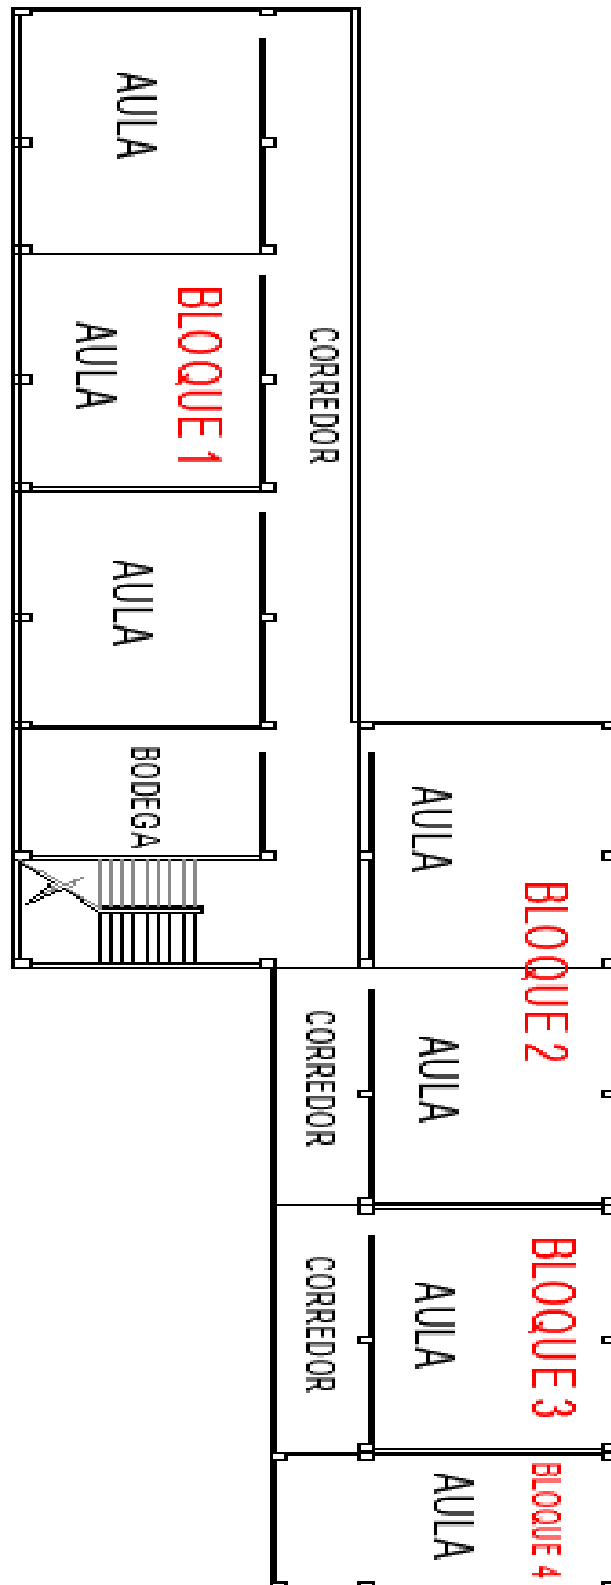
Levantamiento planimétrico de la Planta Baja de la Unidad Educativa “Alberto Andrade Arízaga, Brummel”
